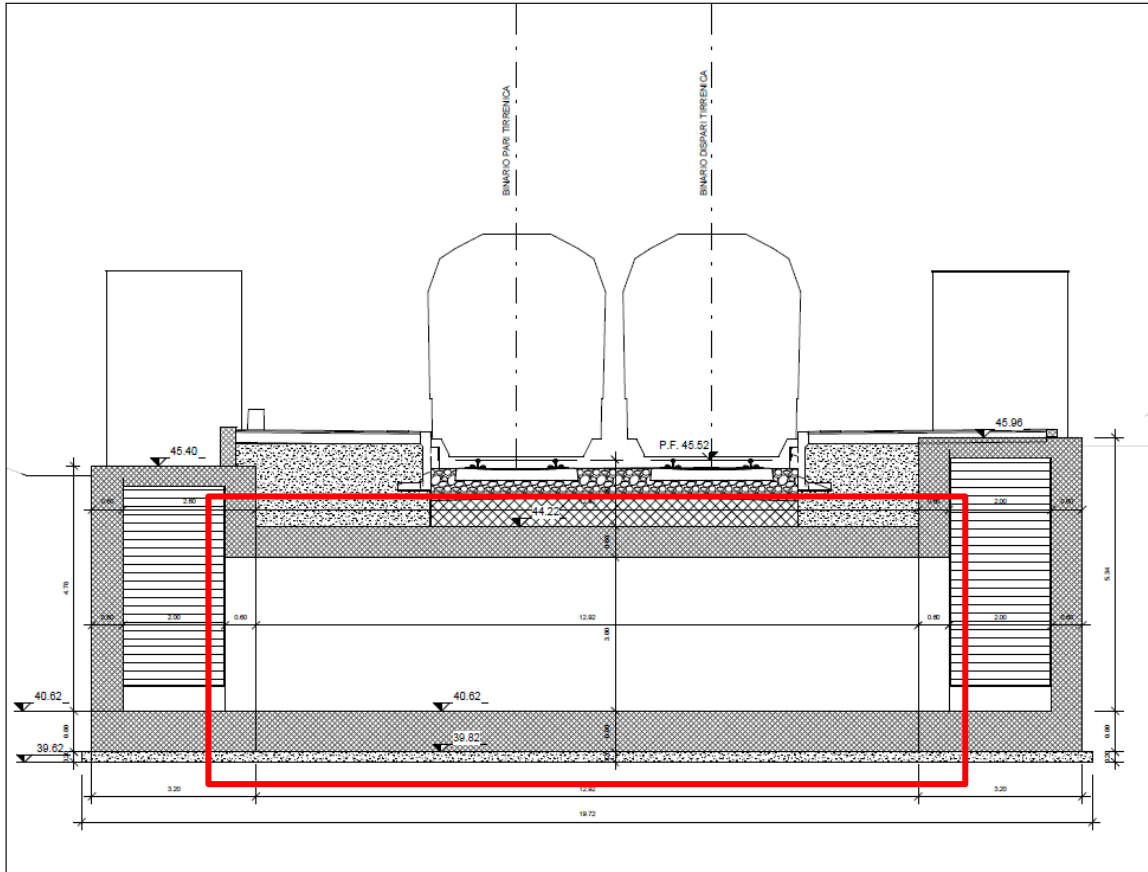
Sezione trasversale dell'opera con individuazione del sottopasso
